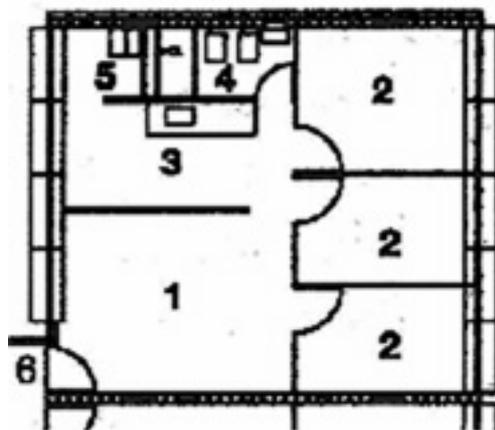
Conjunto Zezinho Magalhães: planta de apartamento
